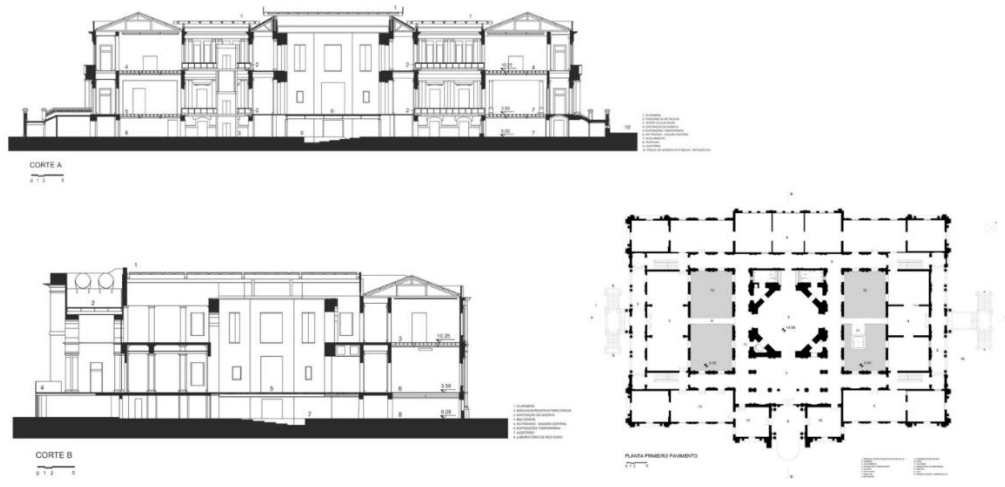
Cortes y plano del primer nivel, Pinacoteca de Sao Paulo, Brasil. Fuente: Plataforma Arquitectura
